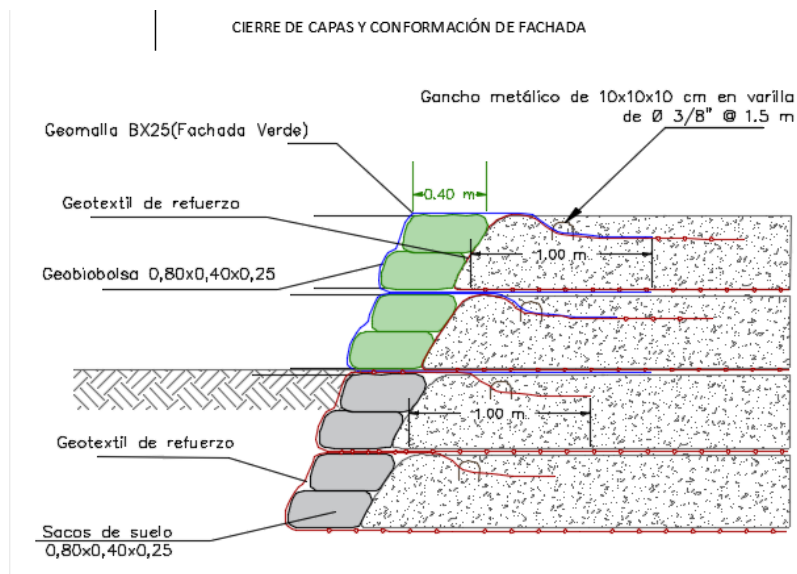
Detalle de fachada con geobiobolsa Fuente: JAM Ingeniería y Medio Ambiente SAS.
